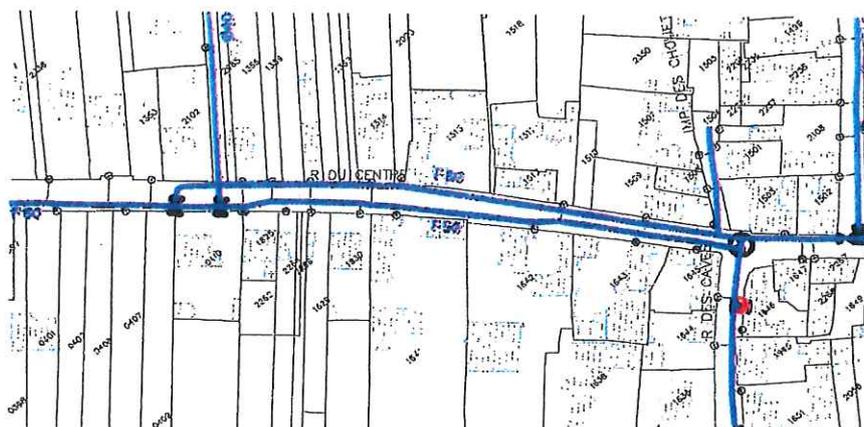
refoulement entre puits et bourg, 2 à 3 conduites en parallèle sur 2.2 km
